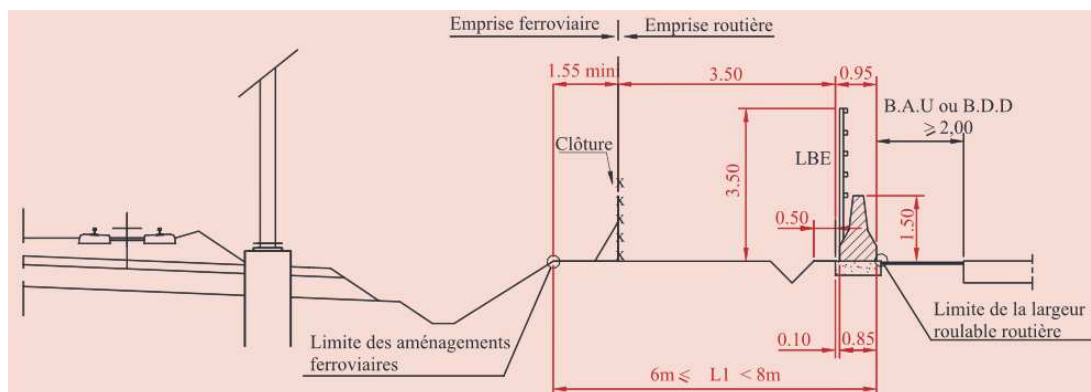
Varianta č.3 řešení – výstavba stěny o výšce 3,5 m a umístění betonové stěny o výšce 1,5 m směrem k železniční trati. U silnice je navrženo betonové svodidlo typu „NEW JERSEY“ o výšce 0,8 m.
